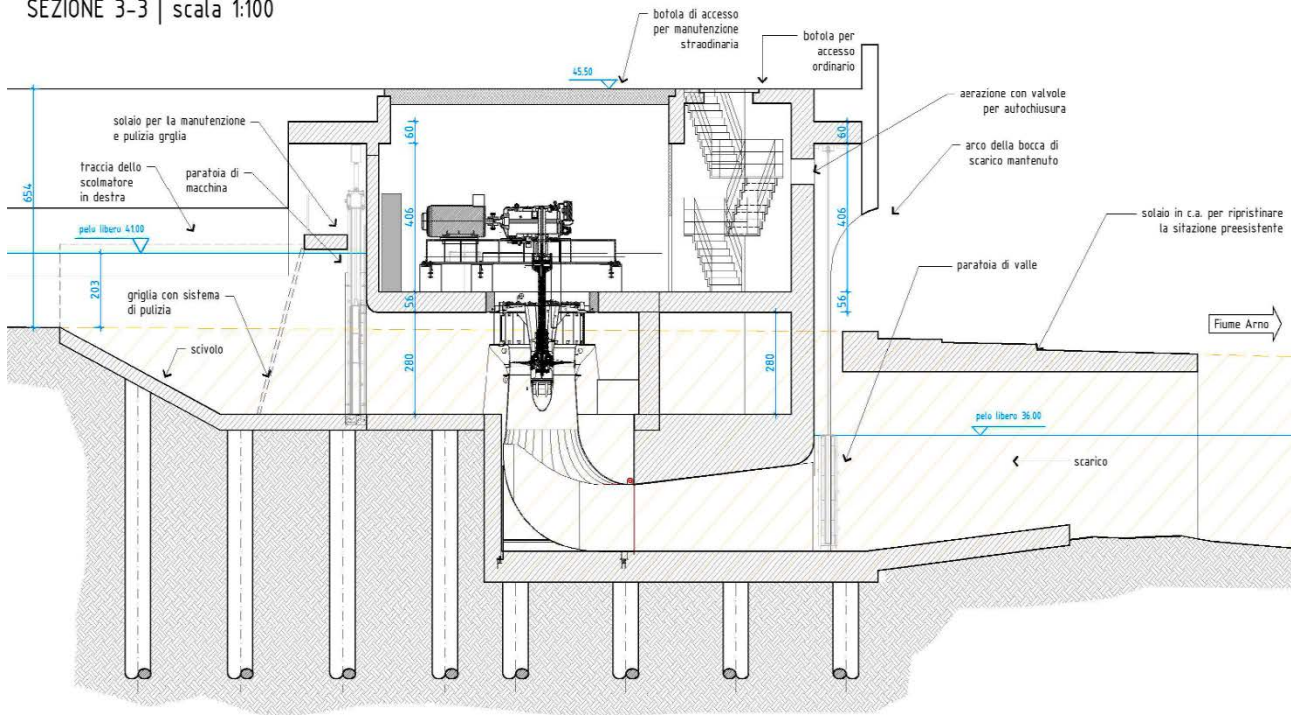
Sezione dell'impianto idroelettrico in oggetto
